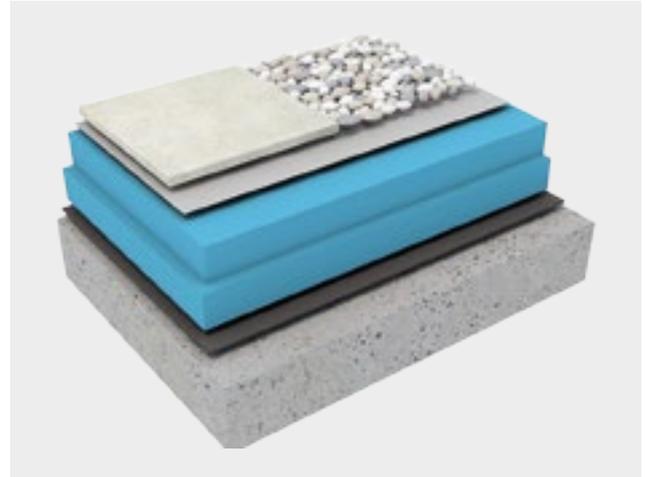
Schichtenaufbau im bekiesten Umkehrdach mit einer bituminösen Abdichtung
